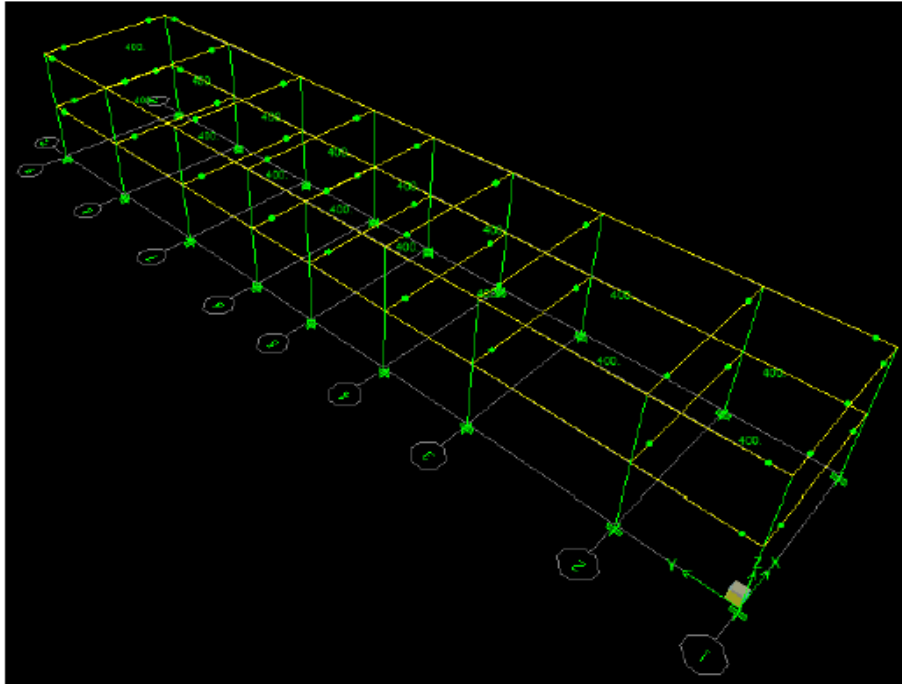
Distribución de Cargas Vivas Sobre Losas - Bloque 2
